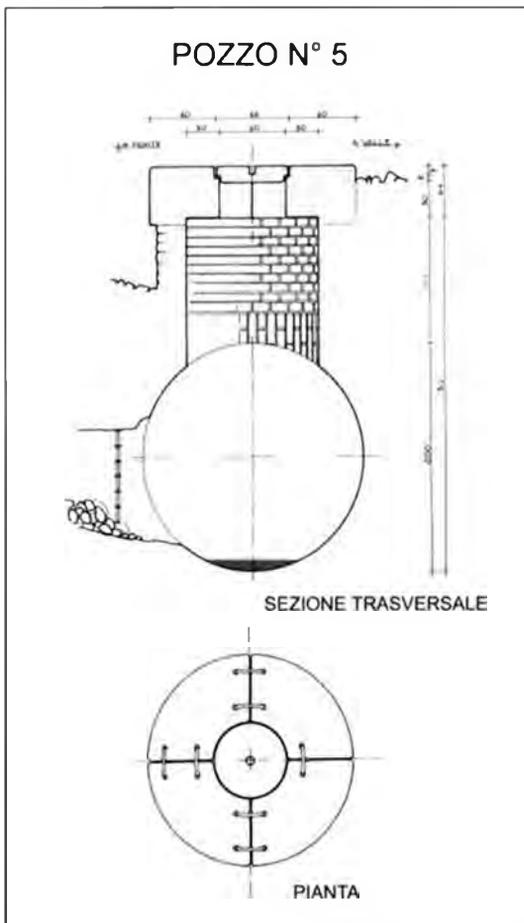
Pianta e sez. del pozzo n.5 (grafica W. Fornella).
